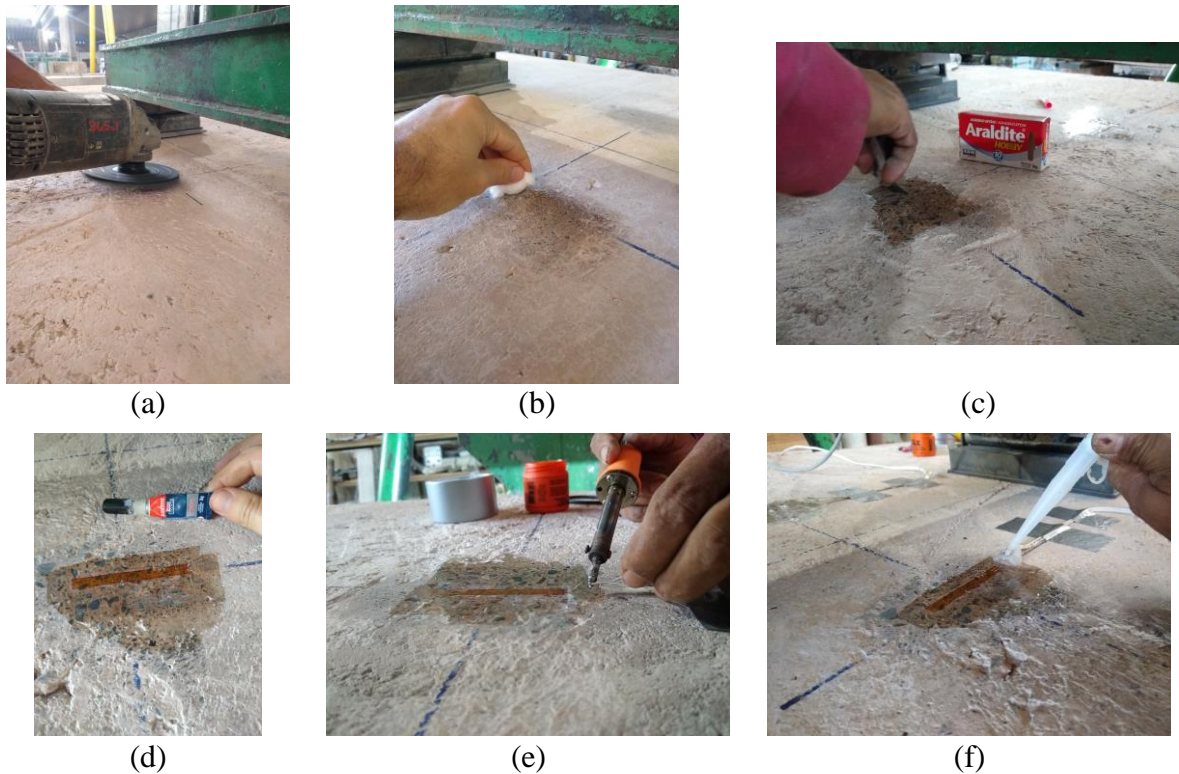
Procedimentos para aplicação dos extensômetros na laje de concreto.
